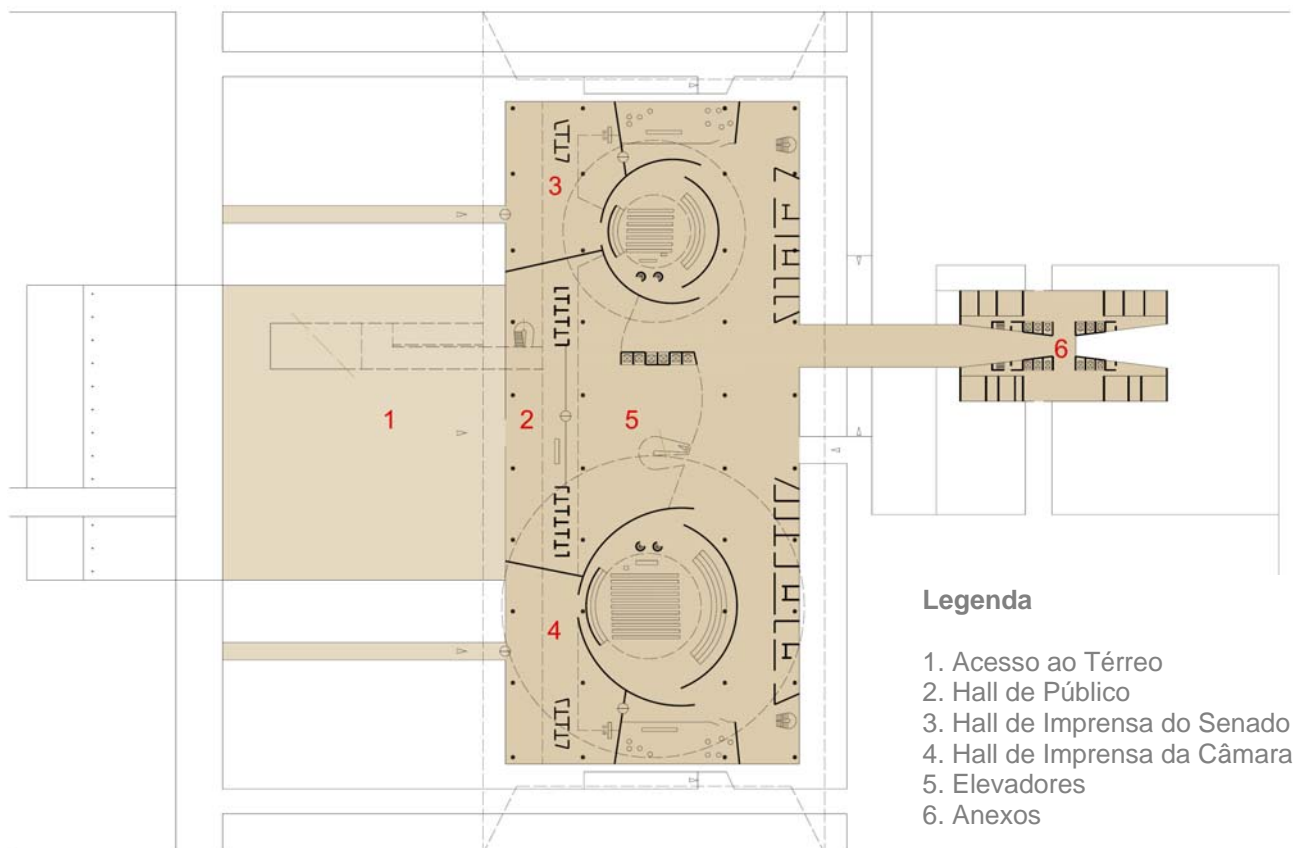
Anteprojet 01 – Planta do pavimento Térreo. 1957.
